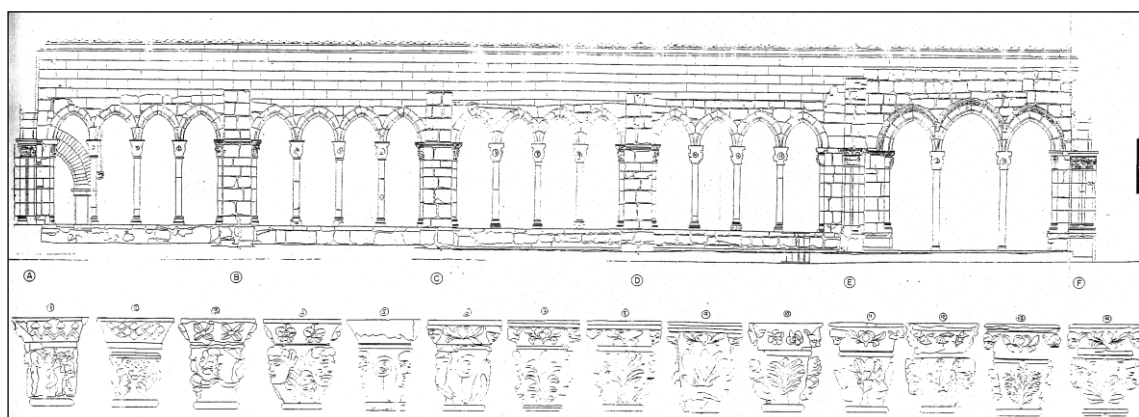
Alzado de la galería sur del claustro. E. Navarro Pallarés, 1996
